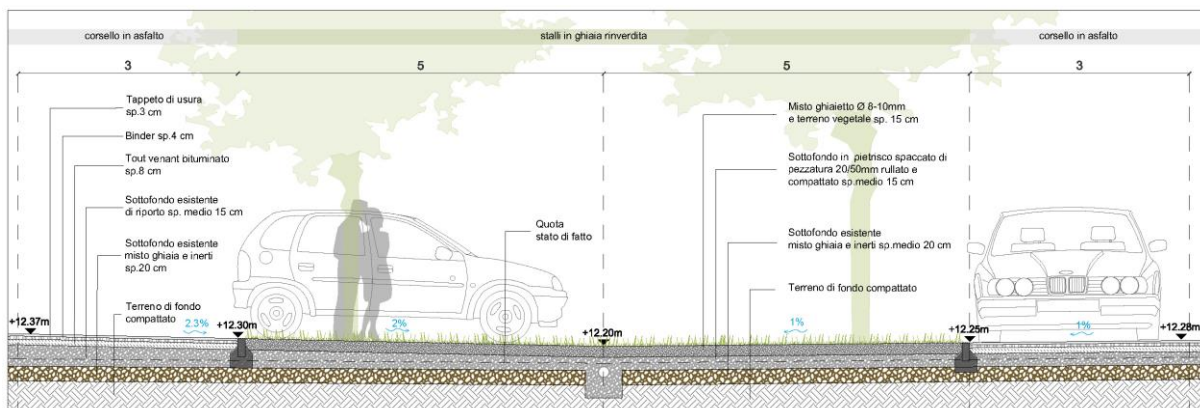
Dettaglio dei pacchetti delle pavimentazioni di progetto in ghiaia rinverdita e asfalto.
